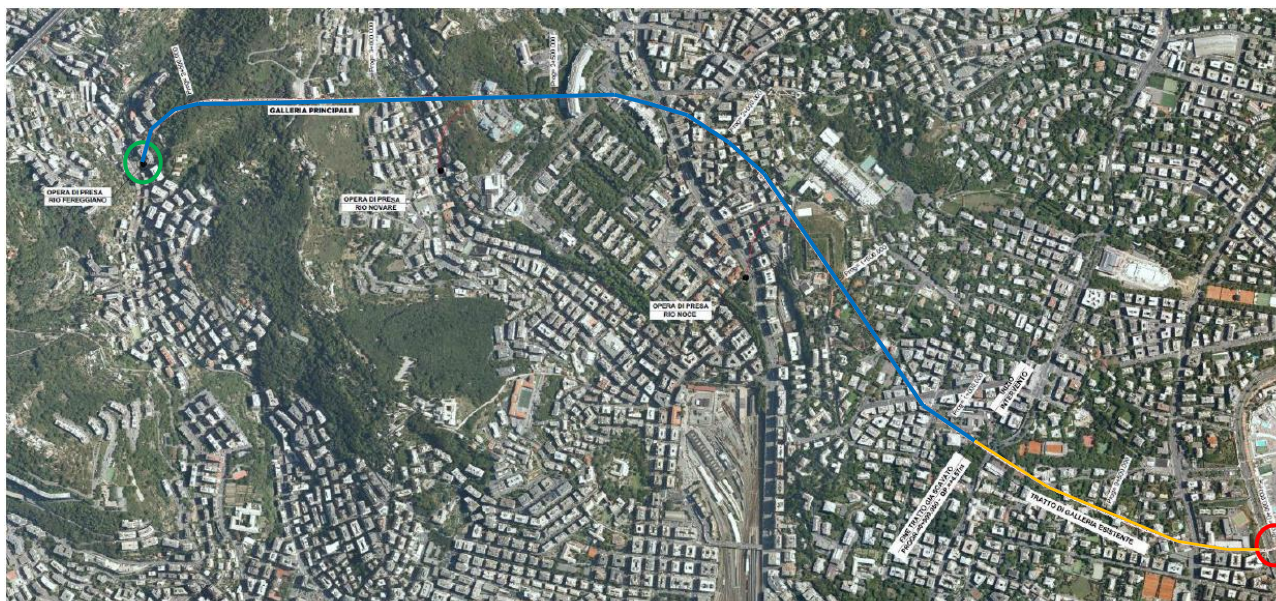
Tracciato di progetto del cantiere delle scolmatore del Torrente Fereggiano
